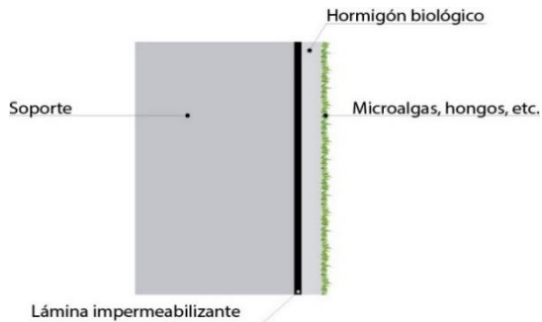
perfil de muestra del hormigón biológico.
